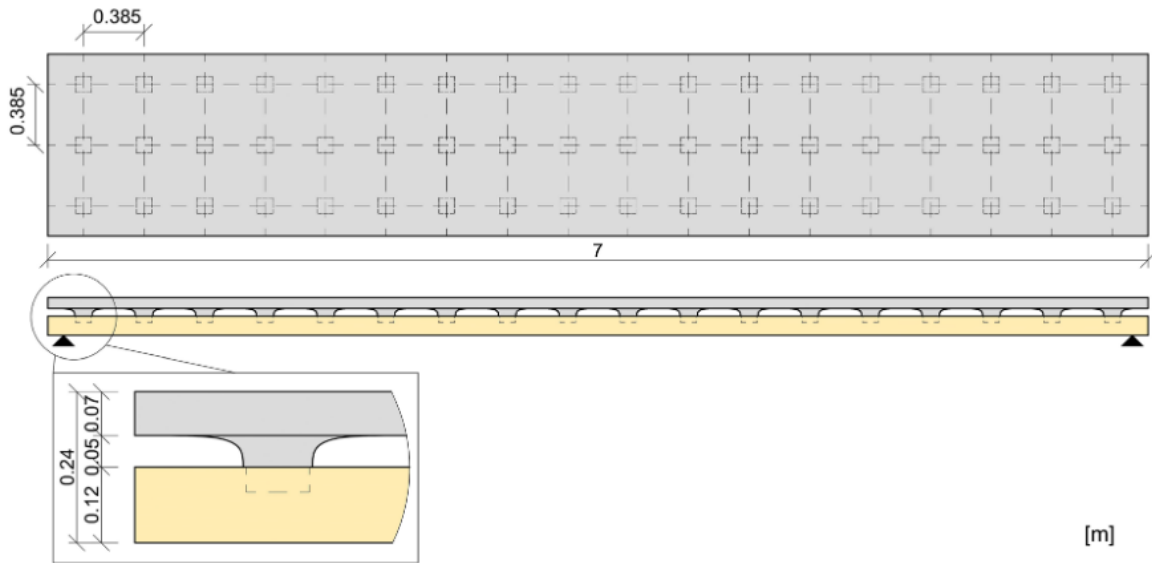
Geometrisch optimierte Holz-Beton-Verbund-Decke (aus [84])
